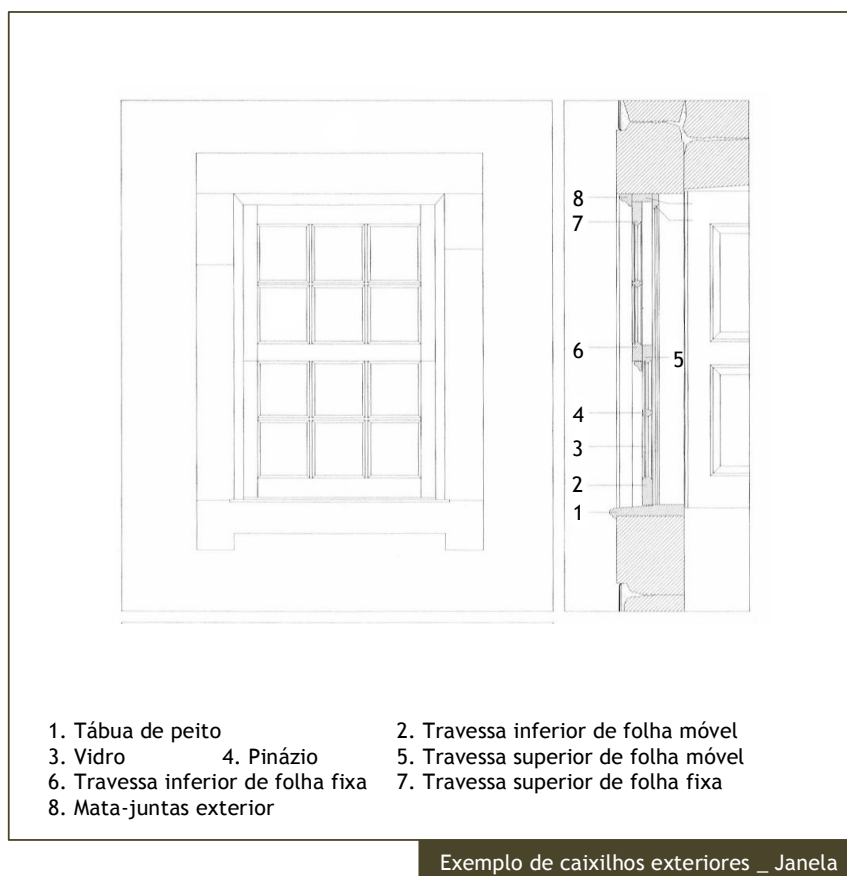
Pormenor Construtivo #7 [i32]
